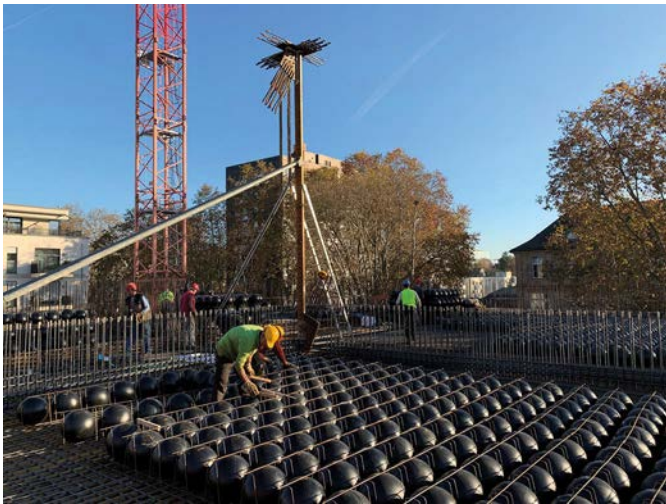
Decke über dem Vortragsraum mit Cobiax-Elementen und Einbauteil zur Hochhängung der Last (Quelle: B + G)
